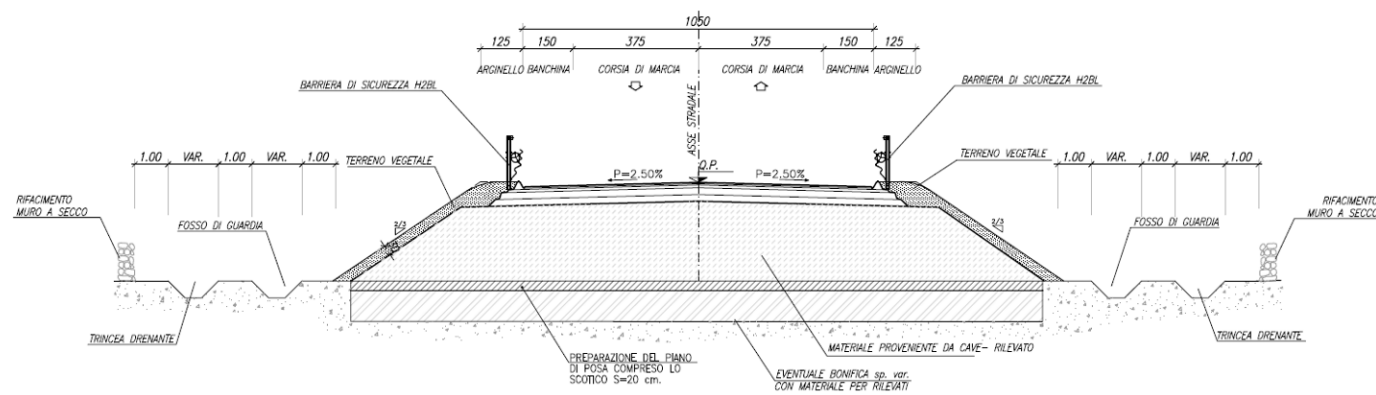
Sezione tipo in rilevato – Asse Principale
